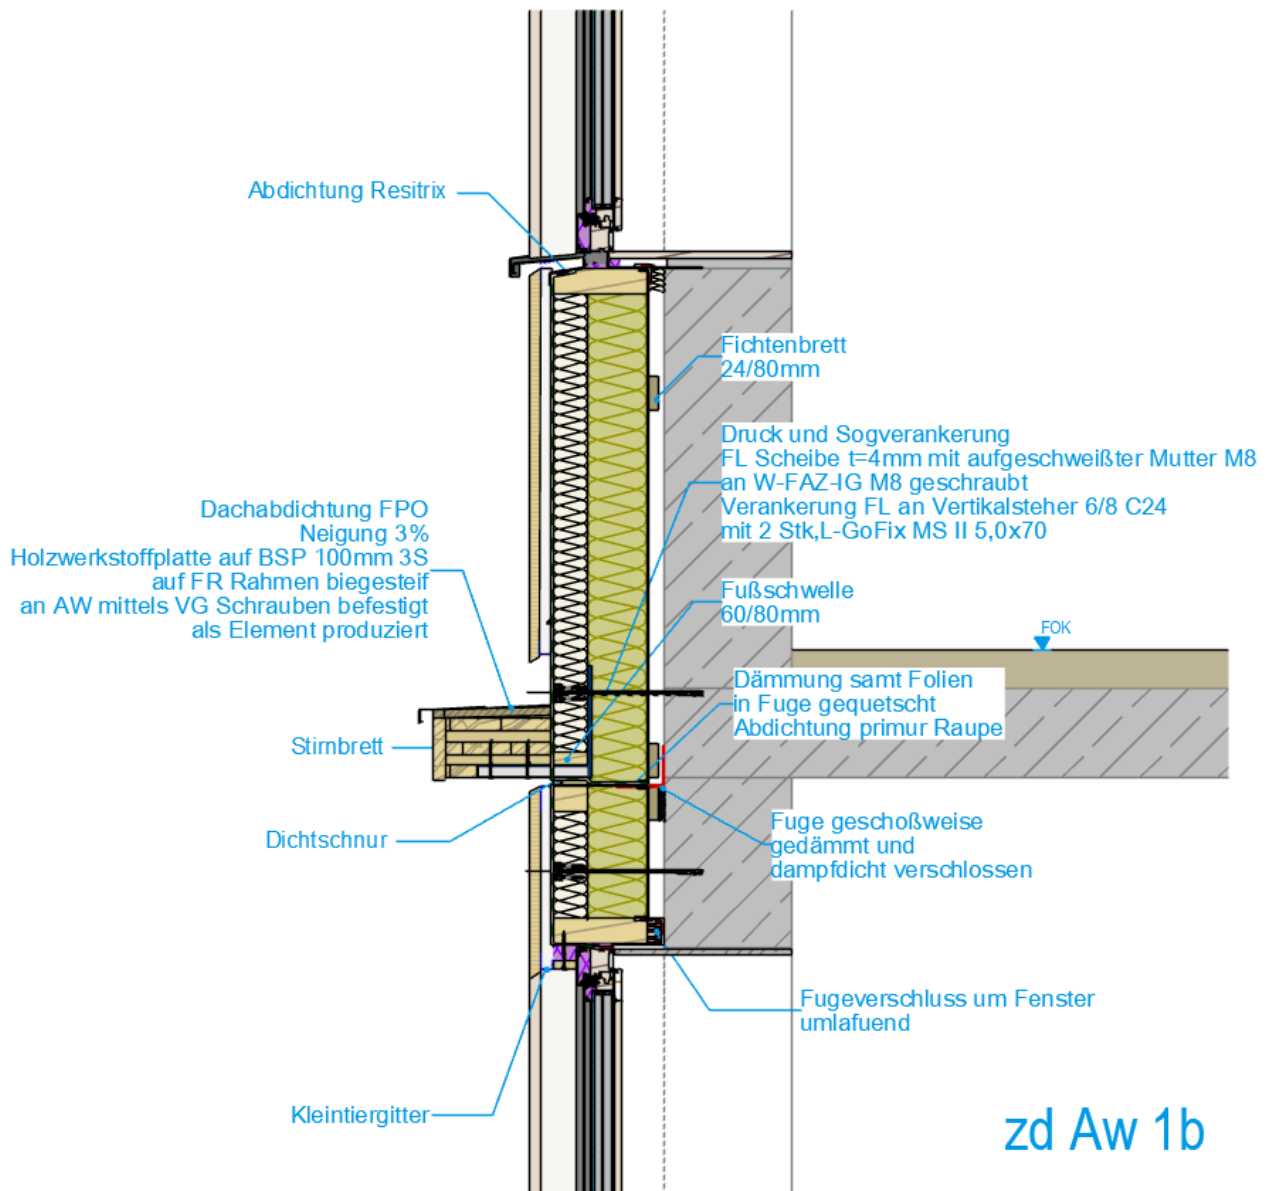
/ Aw 1b - zd – Detail Elementübergang
